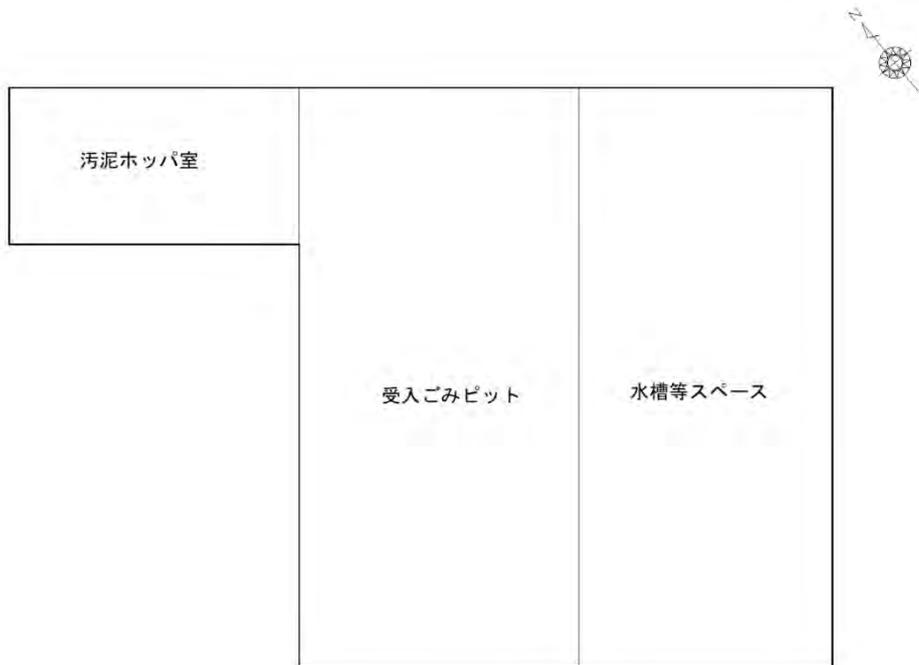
(1) 廃棄物受入棟平面図（地下 1 階）
